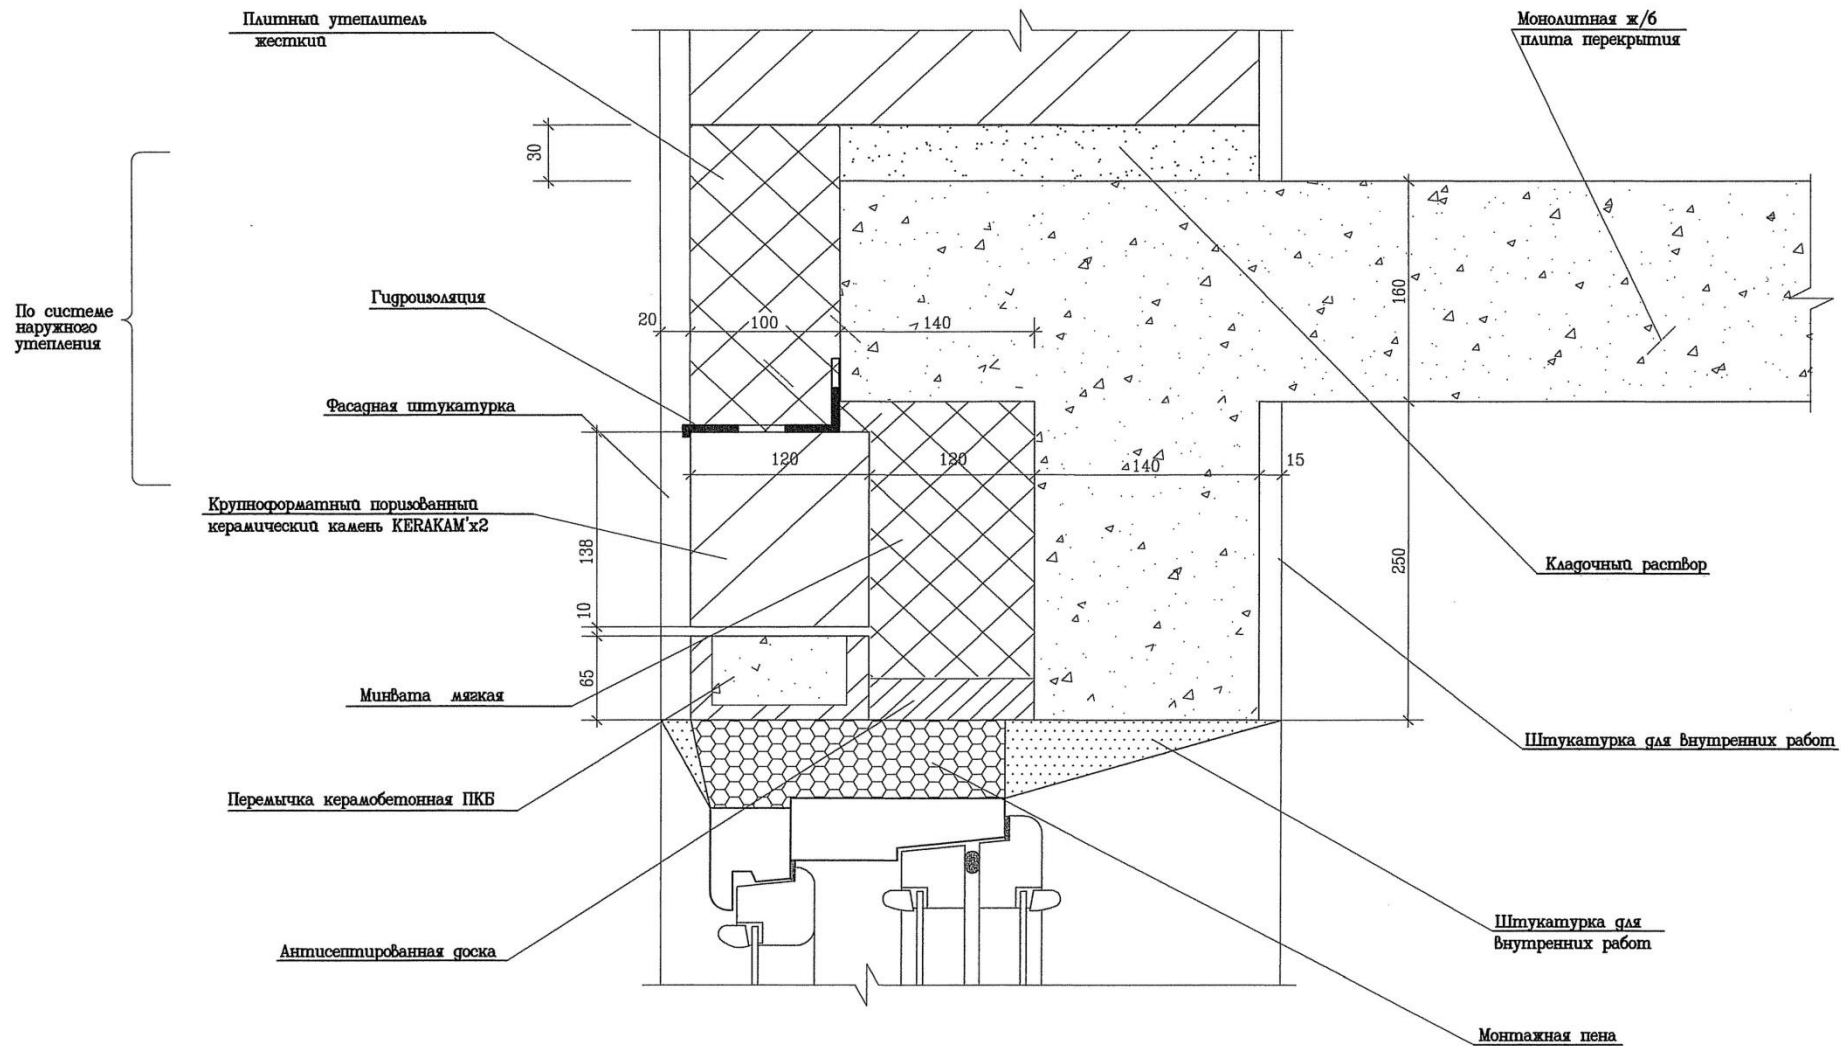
Узел 3 (стены с плитой перекрытия с балкой)
